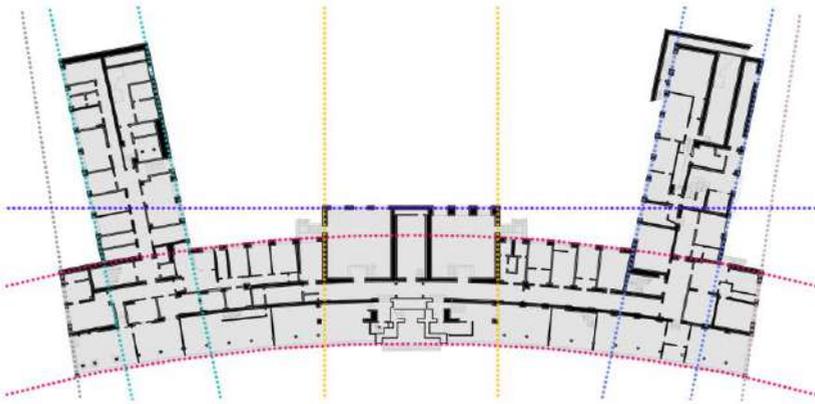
/ Le giaciture dell'Istituto di Botanica, pianta del piano terra.
